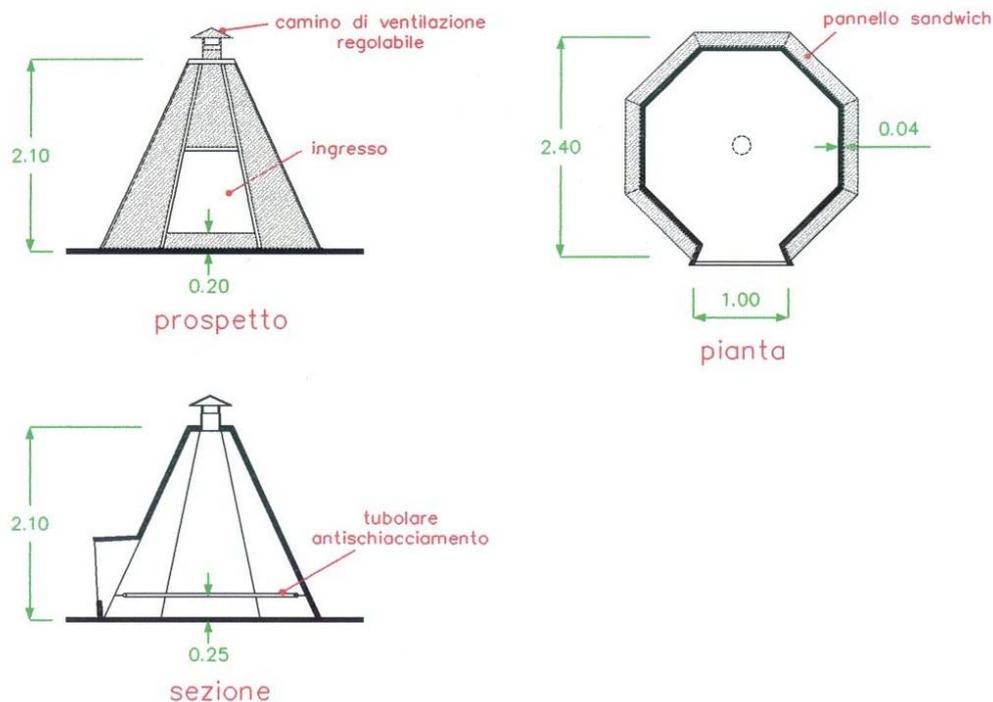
Pianta, sezione e prospetto della capannina a “piramide” per la fase di maternità
